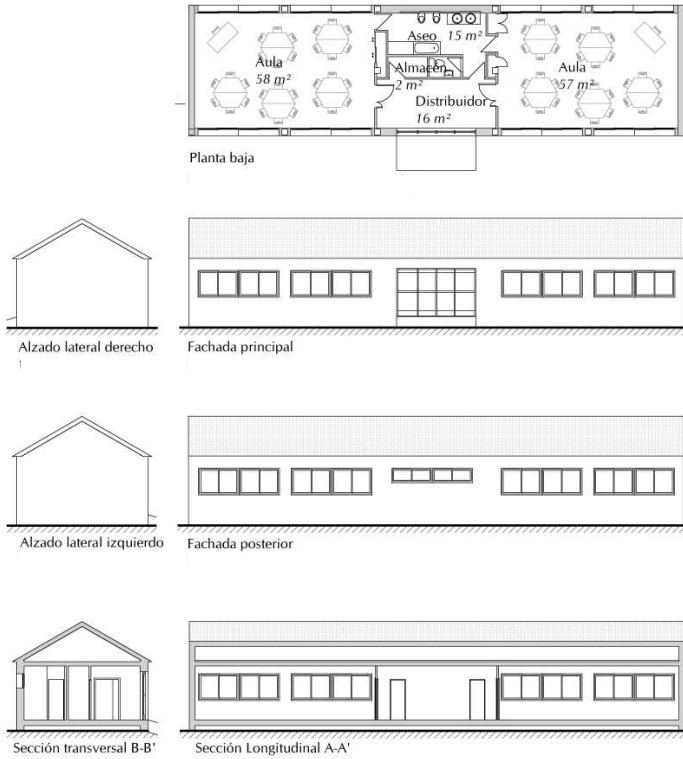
CEIP Bartolomé Cossio: aula de infantil: plano de planta y alzado principal. Fuente: elaboración propia.
